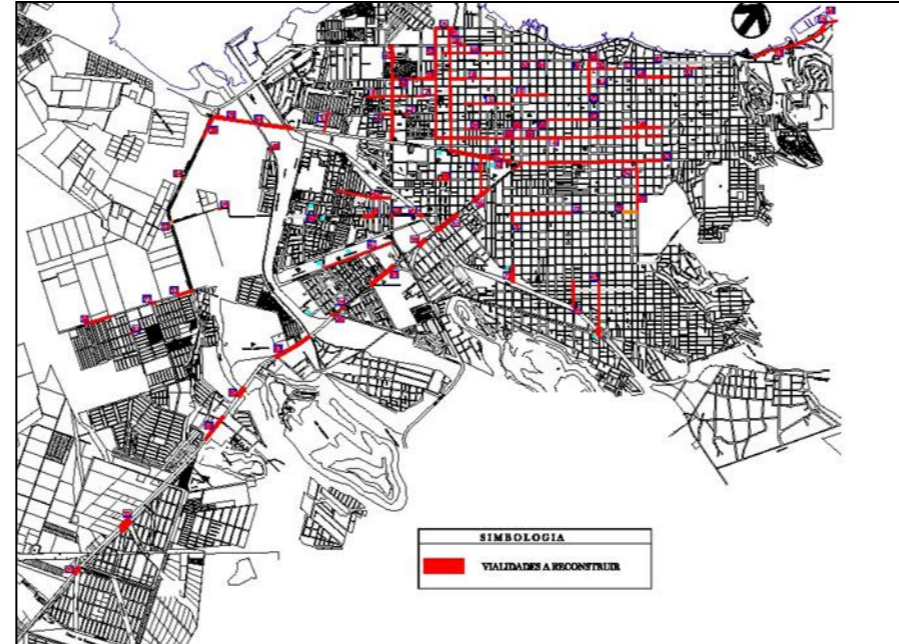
Vialidades a repavimentar. Fuente: Secretaría de Planeación Urbaan Infraestructura y Ecología BCS.
